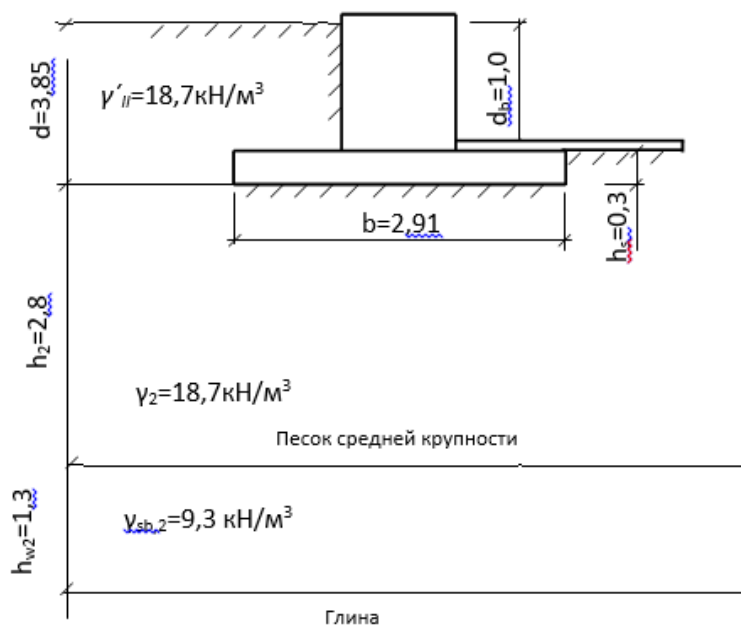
Схема расположения фундамента мелкого заложения в грунтовом массиве
